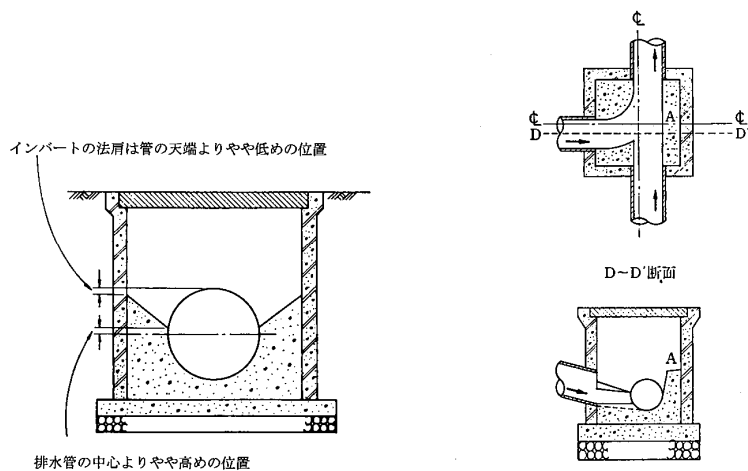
インバートの の施工 図6-6 形に合流する場合の施工
